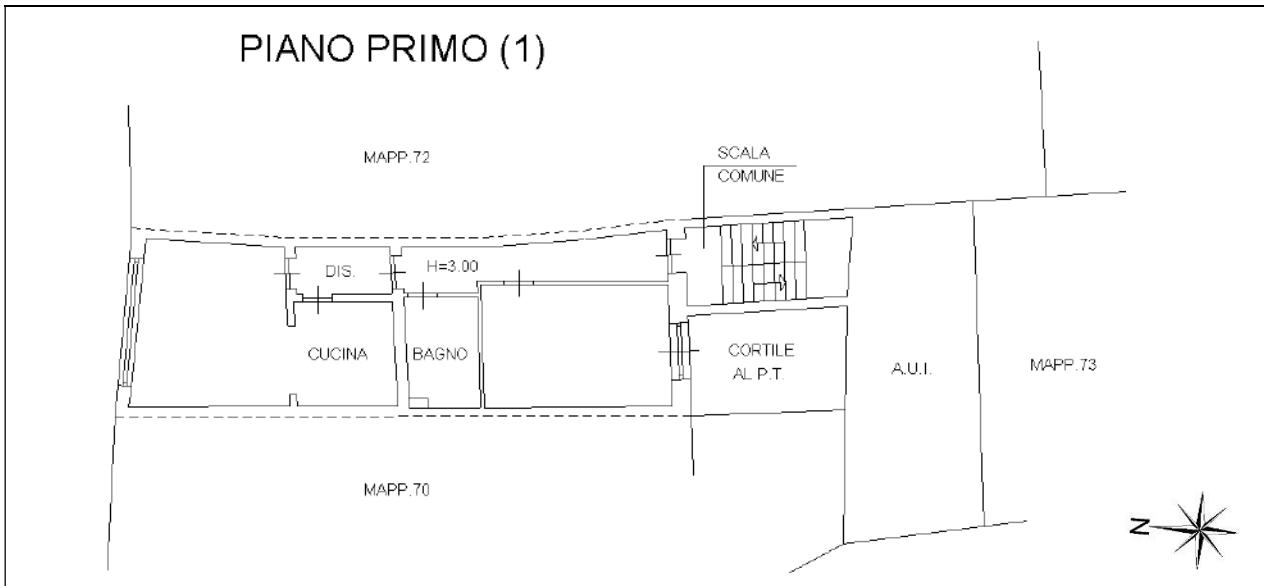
Estratto planimetria catastale Sez. Urb. NCT Fg. 31 particella 71 sub. 3 in banca dati dal 17.11.2014 – piano primo
